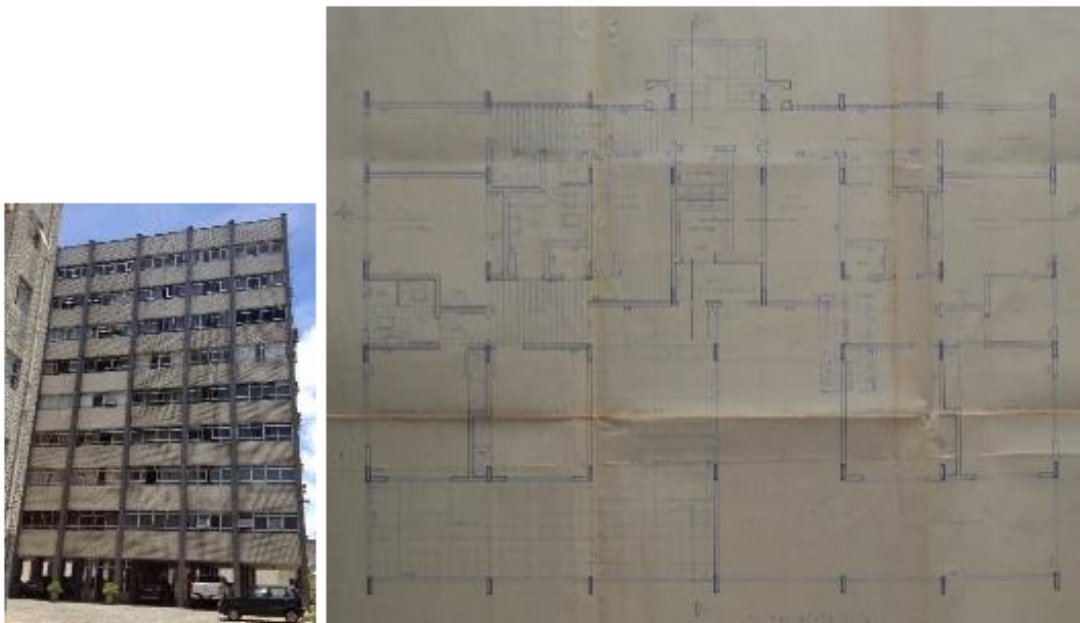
Edifício Jangada e planta baixa do apartamento tipo.
